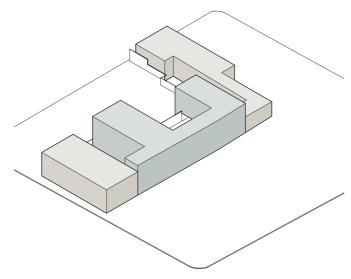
Axonometría Planteamiento de Volumetrías generales Fuente: Autores, 2022
